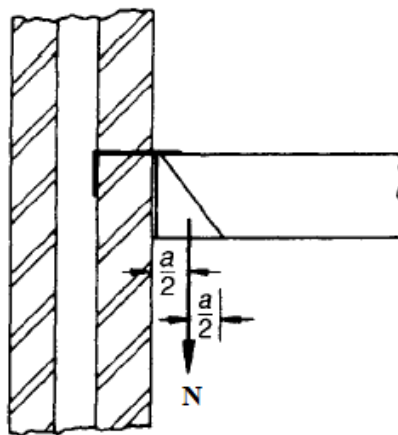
Posição assumida com a utilização de ganchos para vigas (Adaptado de HENDRY, *et al*, p. 103).
